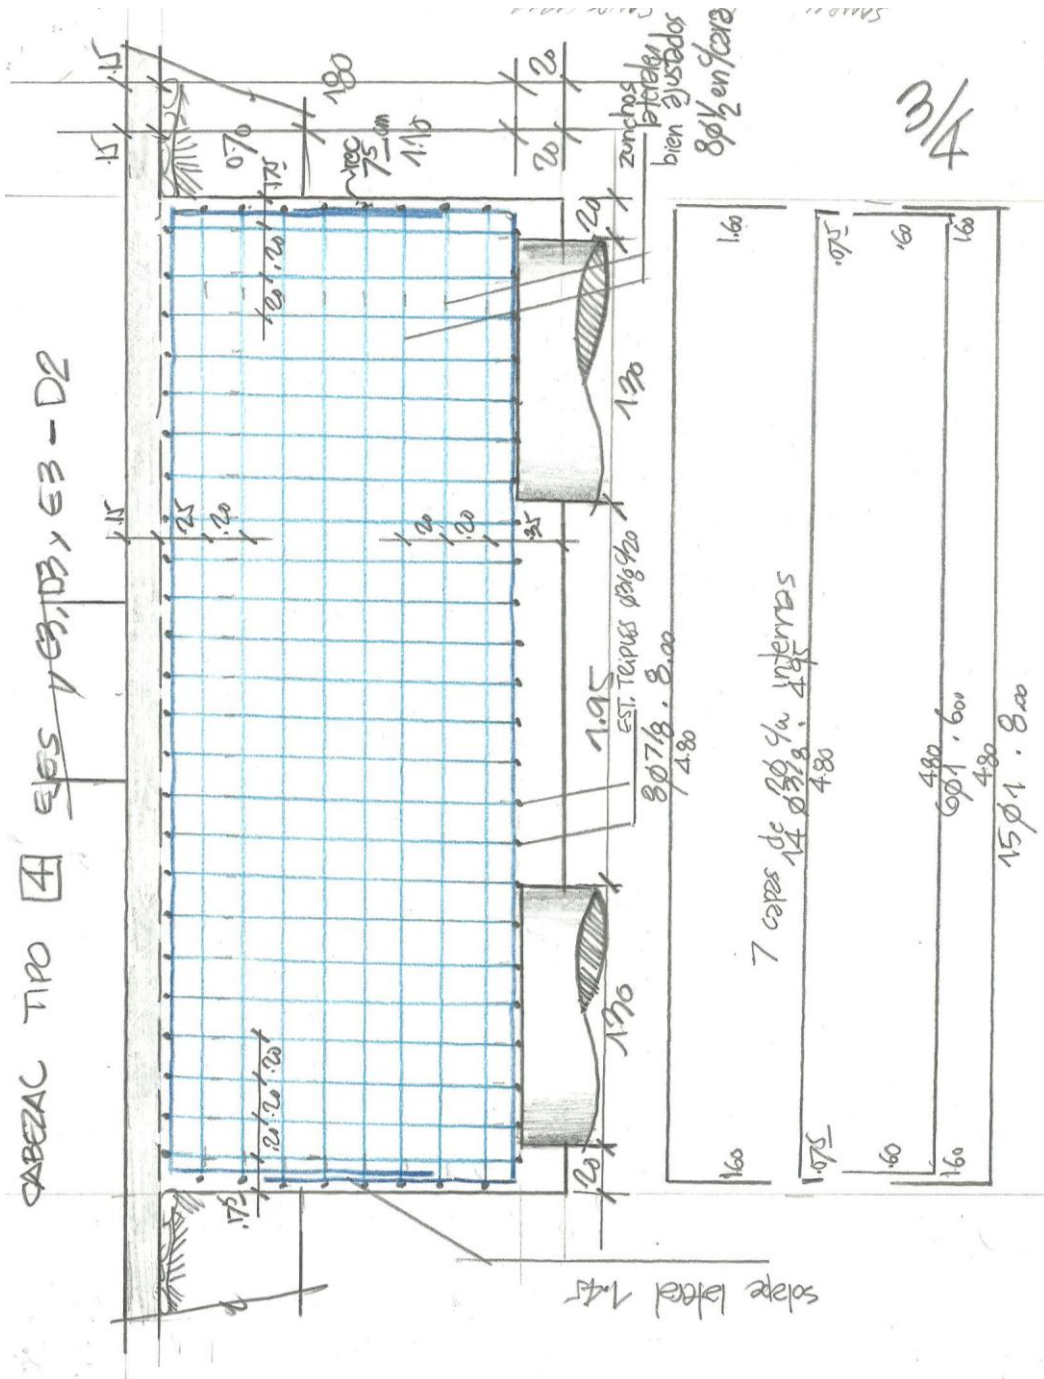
Detallado del acero de refuerzo de cabezal sobre dos pilotes.
